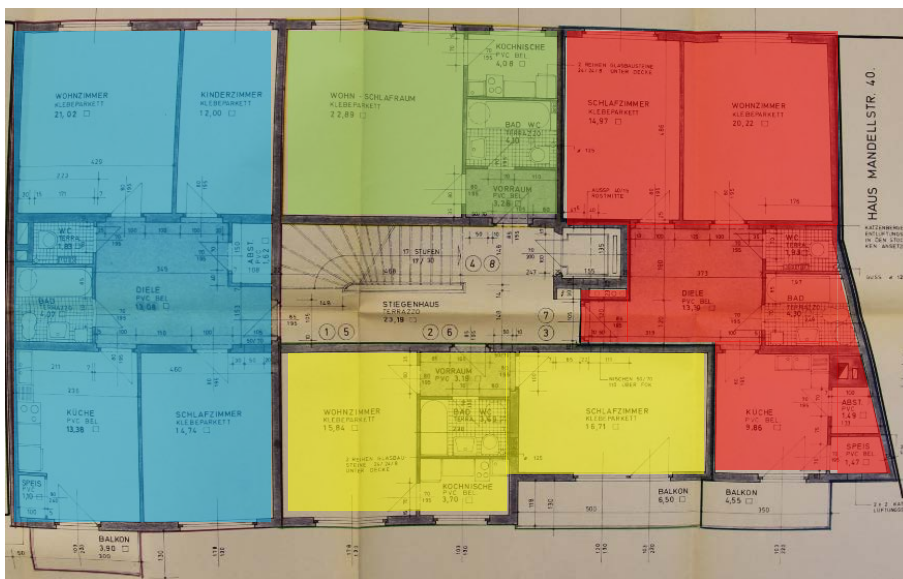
Grundriss eines innerstädtischen Wohn- und Geschäftshauses in Blockrandverbauung von 1967<sup>151</sup>
